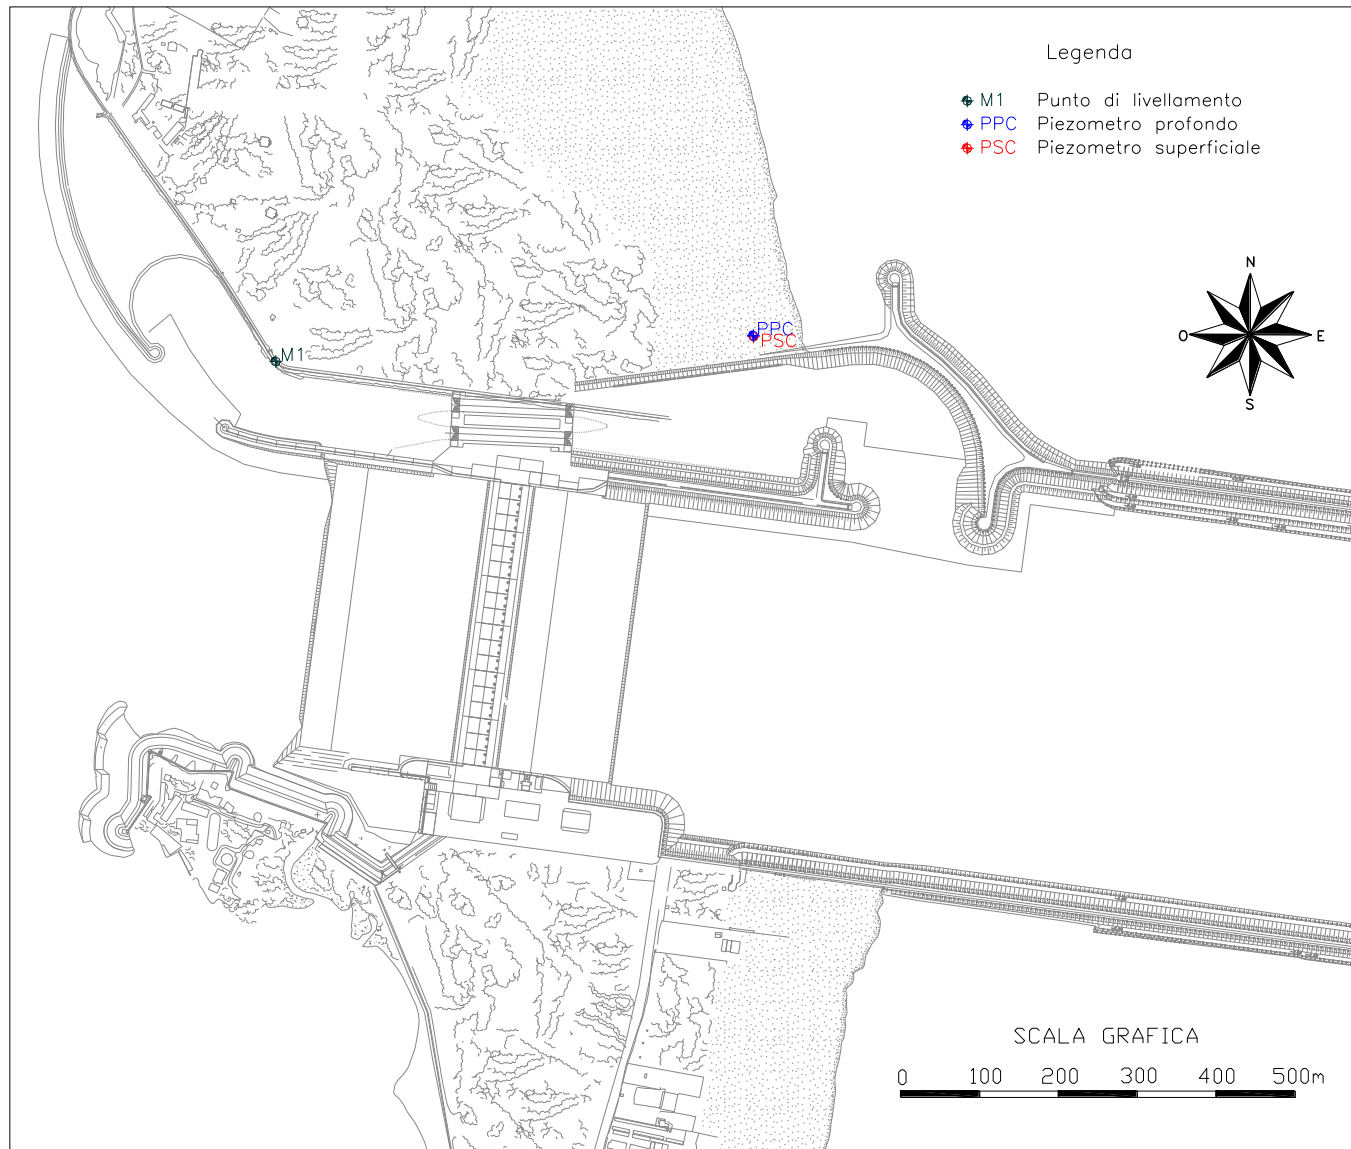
Planimetria dell'area di cantiere ed ubicazione della postazione di monitoraggio
